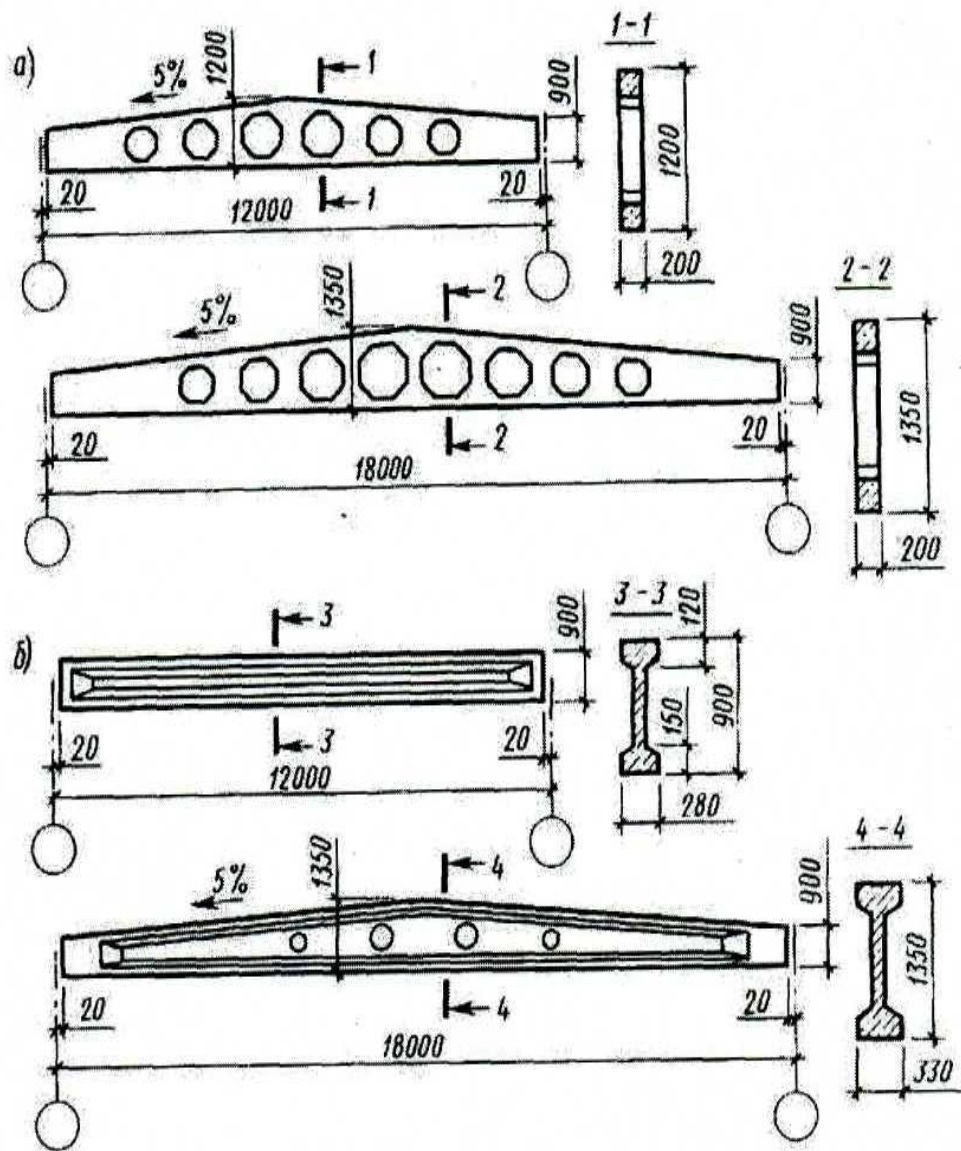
Стропильные железобетонные балки: а- решетчатые для скатных кровель пролетом 12и 18 м; б- сплошная для плоской кровли и сплошная двутавровая для скатной кровли пролетом 12,18 и 24 м
